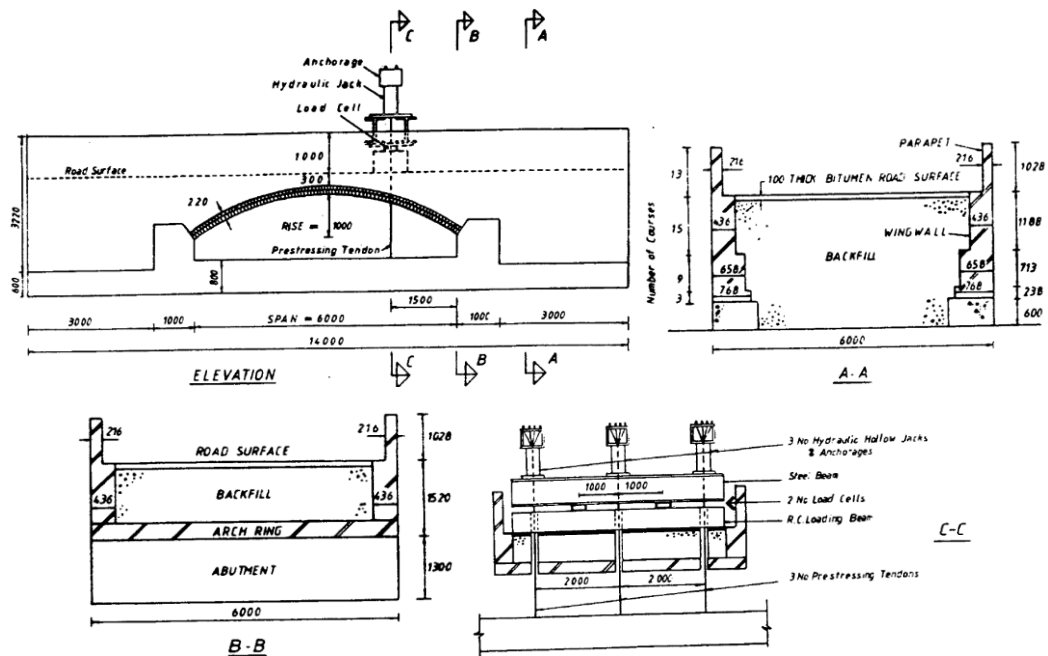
Bolton Model: sezione longitudinale e trasversali con indicazione dell'applicazione del carico. [52]
